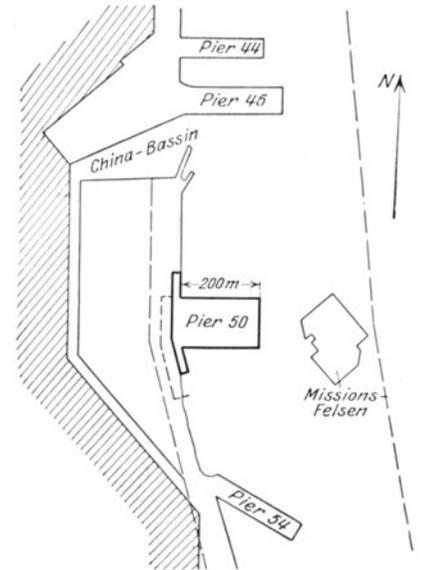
Lageplan des im Bau befindlichen Piers 50 (vorläufiger Ausbau).
